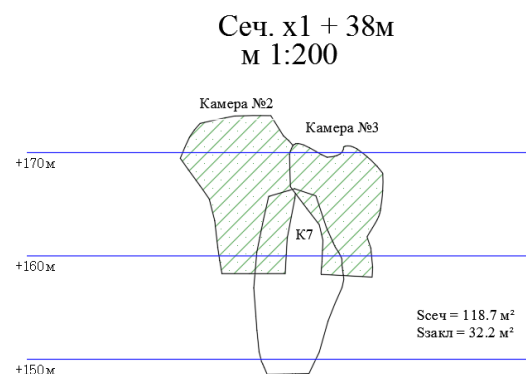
Формирование подработки закладочного массива с кровли камеры:
